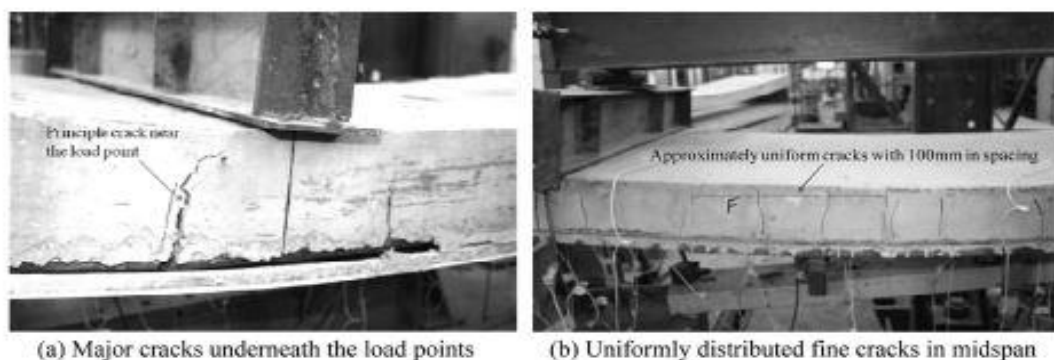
Fissuração em ensaios de flexão (adaptado [10])
